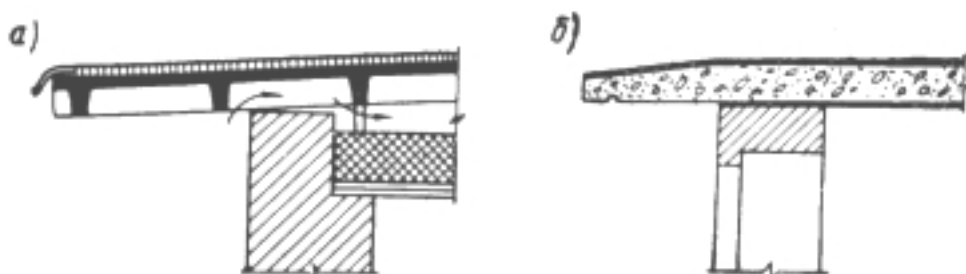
Совмещенные крыши. а — с вентиляционными продухами; б — из сплошных панелей
